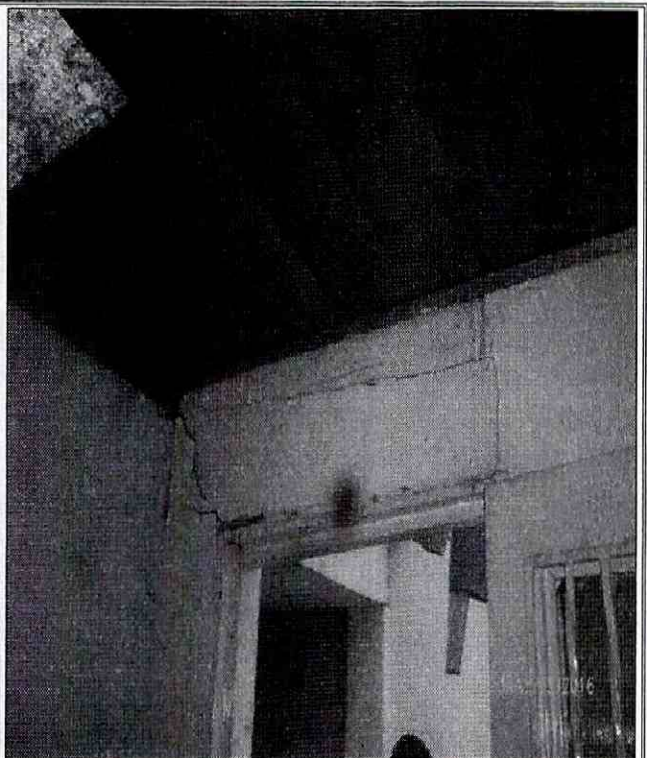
Grietas identificadas en muros de cerramiento y divisorios de la vivienda ubicada en el predio de la Calle 104 No. 58 A – 12, en el Sector Catastral Puente Largo de la Localidad Suba.
